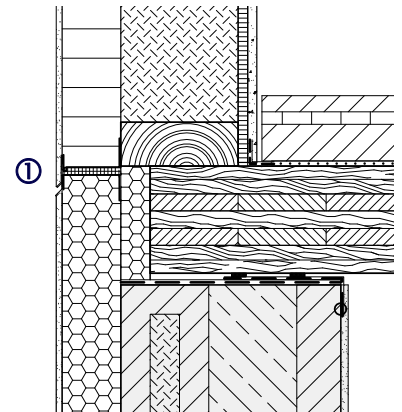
Wie Abb. G4.10, jedoch mit einer Fertigteil-Deckenkonstruktion aus Holzmassiv-elementen
